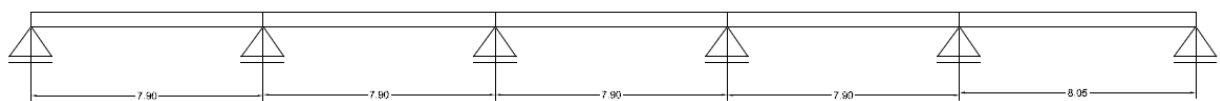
Viga cobertura, 0,25x0,70 m<sup>2</sup>
